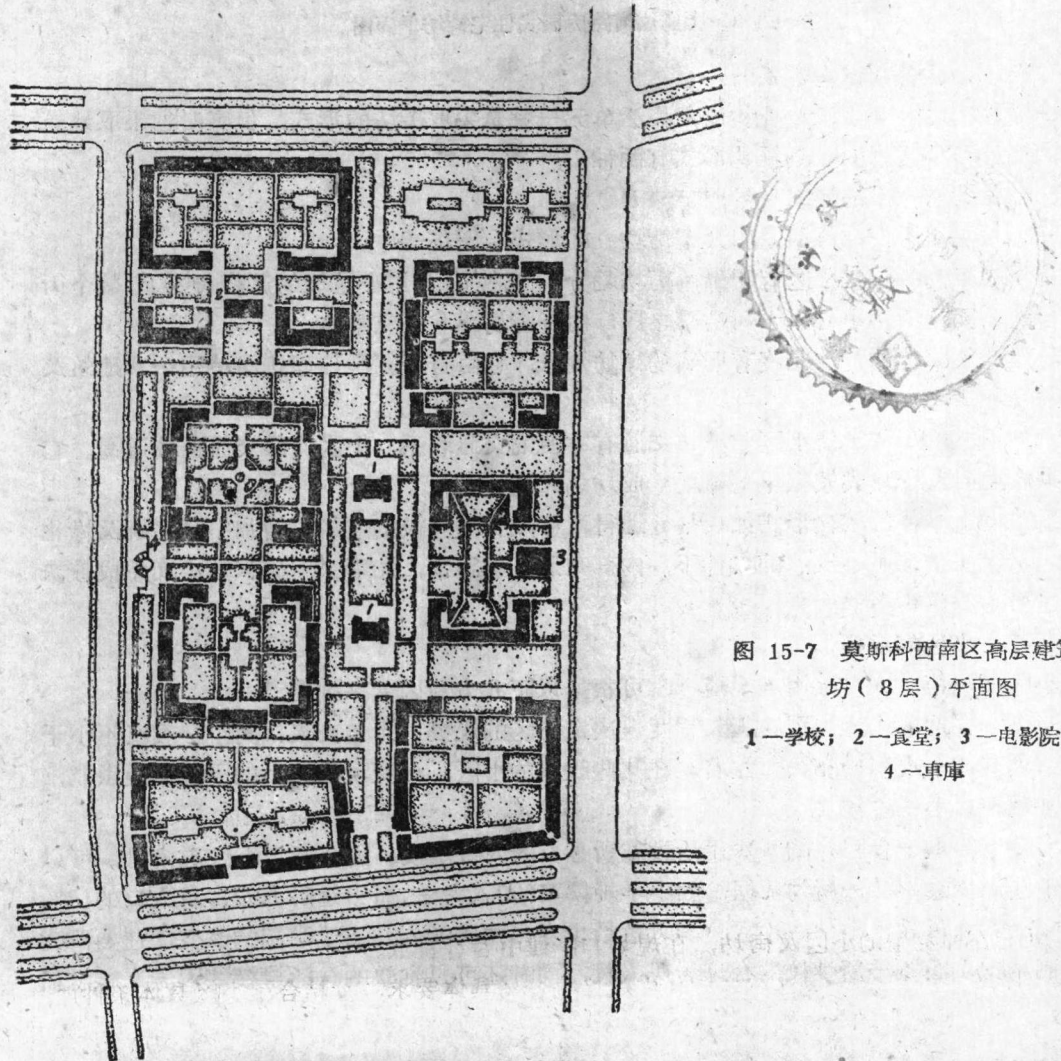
莫斯科西南区高层建筑街坊(8层)平面图
